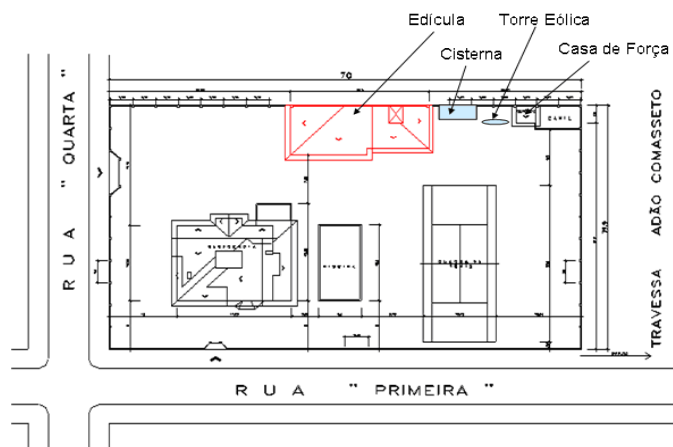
Planta situação/localização onde será instalado o sistema de captação de água de chuva, e eólico. Escala 1/200
